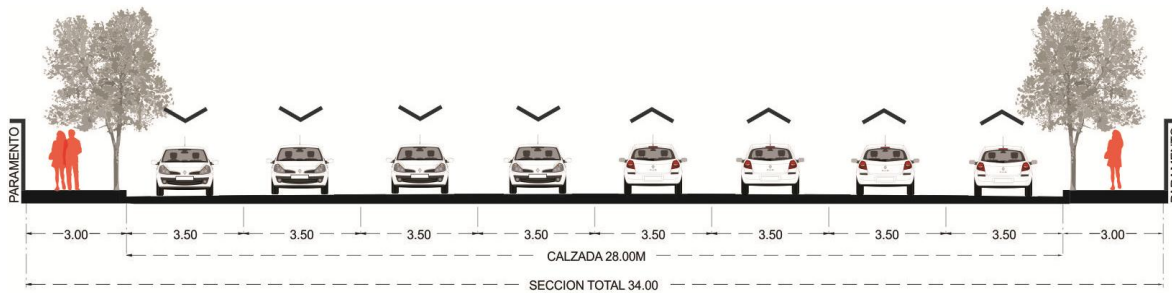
Sección Primaria 4 carriles por sentido.
